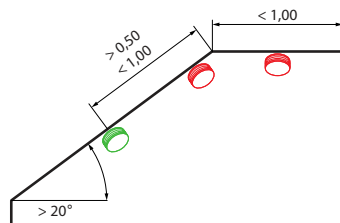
Gerade Montagefläche weniger als 1 m lang und 1 m breit
